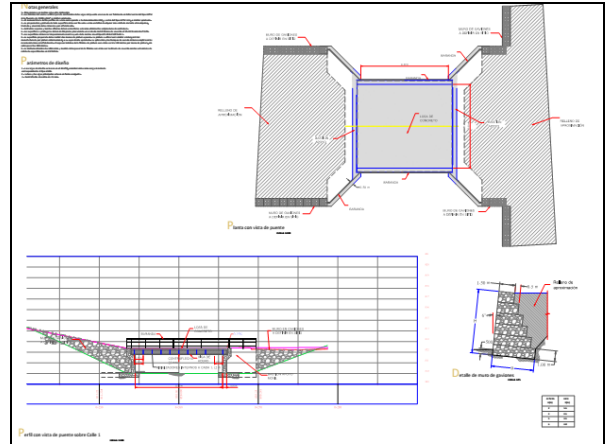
Detalle de perfil y planta del puente sobre Quebrada sin nombre Norte (Ver Apéndice, Lámina 19).
